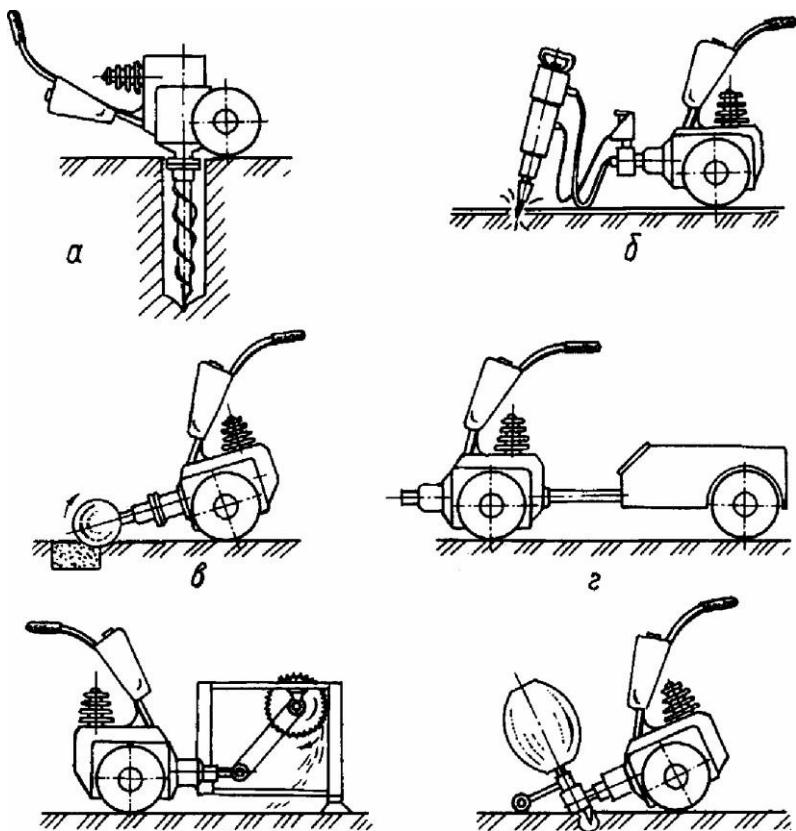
Навісне й причіпне робоче обладнання на базі механізованого землеройно-транспортувального інструменту: а - бур; б - пневмомолот; в - пилка для розрізування бордюрних каменів; г - мототачка; д - пилка для розрізування деревини; е - розчиннозмішувач
